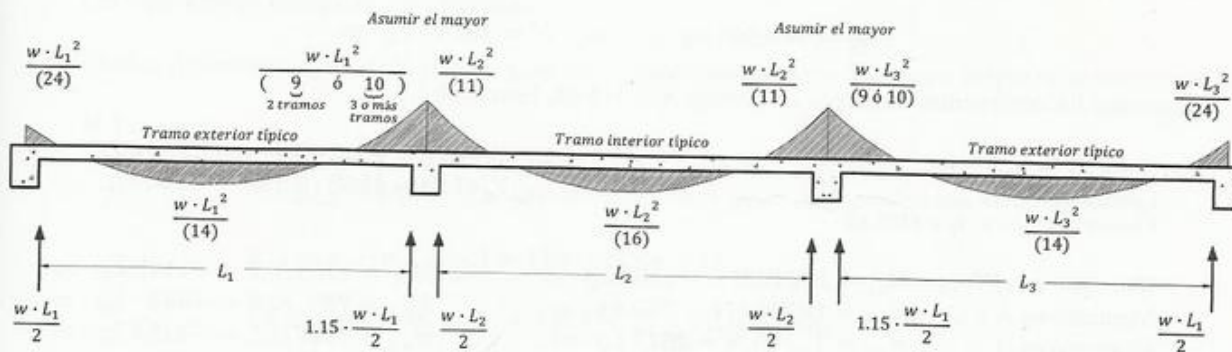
Coeficientes aproximados para calcular momentos y cortes en losas y vigas
